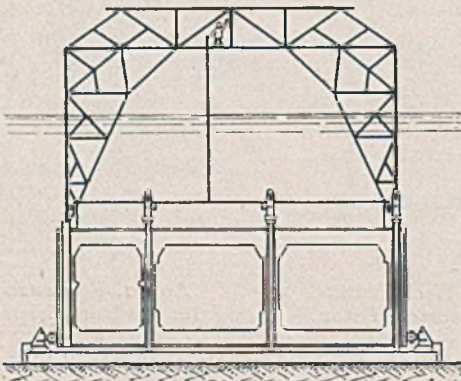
Tunnelement mit Pendelstützen und Querlager.
